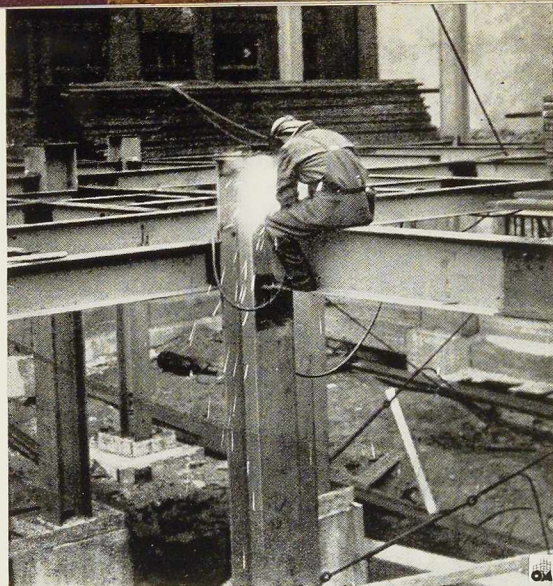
Un soudeur procédant à l'assemblage d'une colonne à une poutre.
